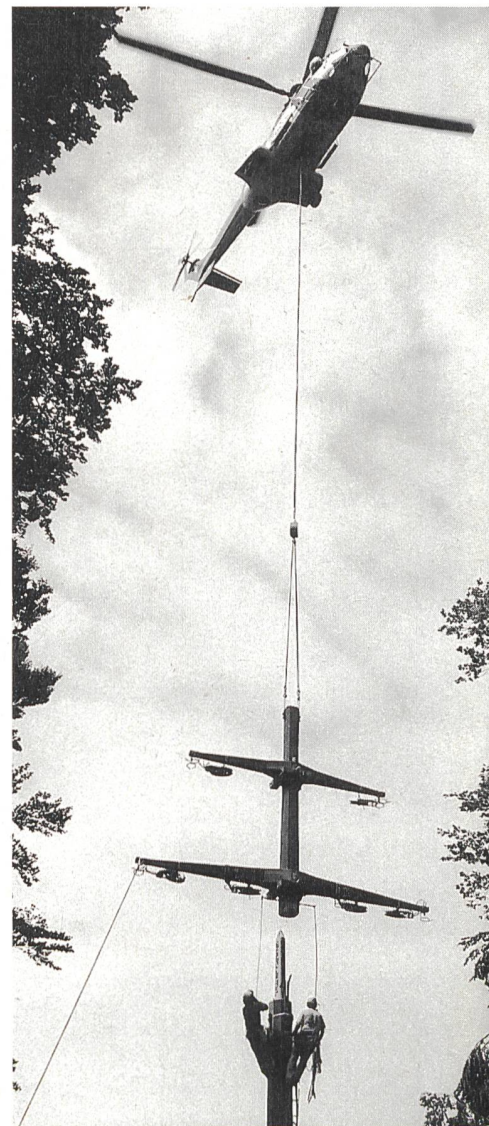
Setzen des oberen Teils des achtekigen Mastes mit Trägern.
